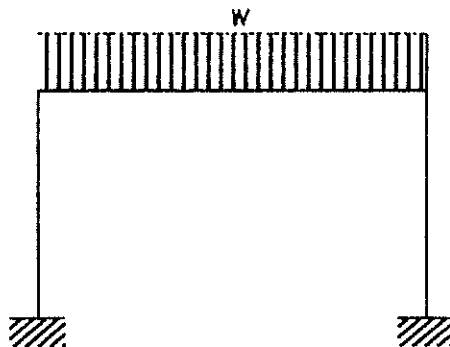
(Estructura con carga uniformemente distribuida)
